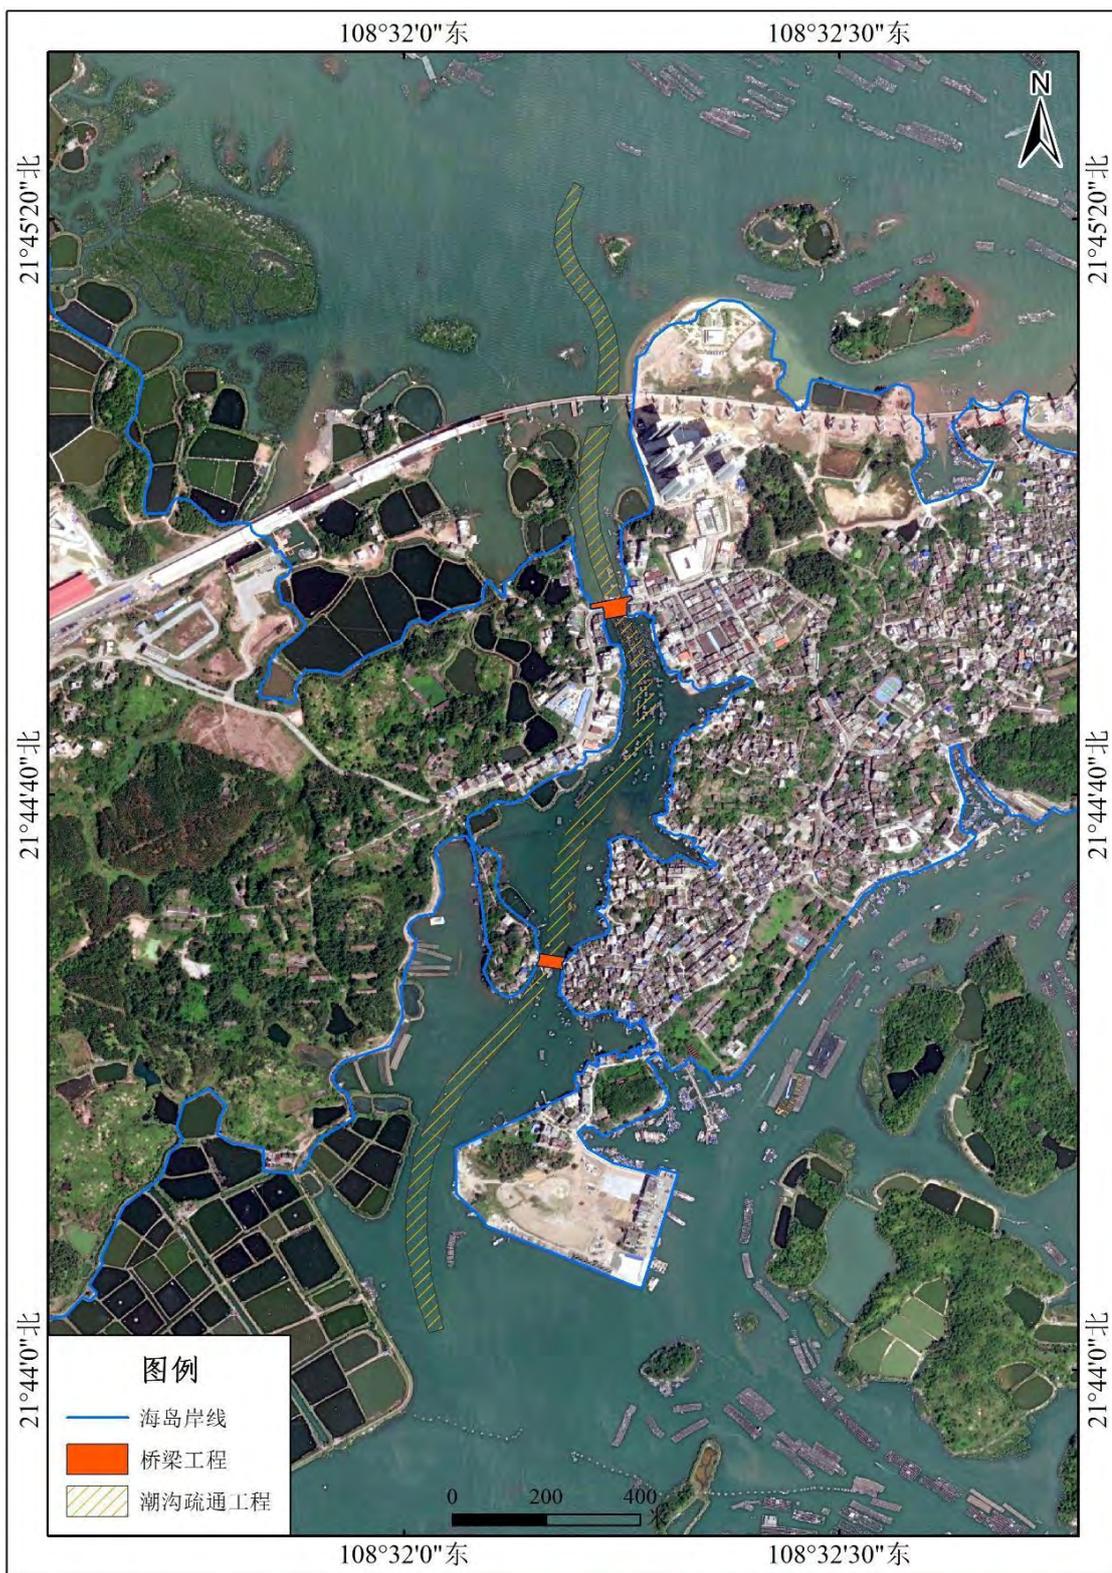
潮汐通道疏浚总平面布置图 1
